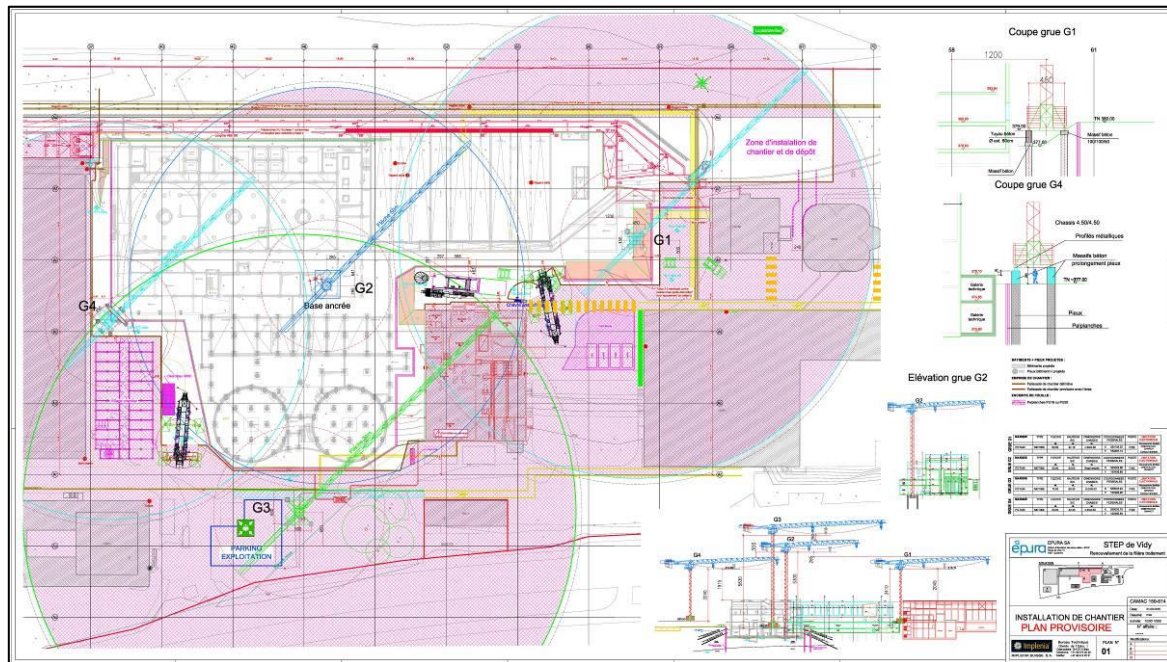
Plan d'installation chantier Implenla Sept. 16
